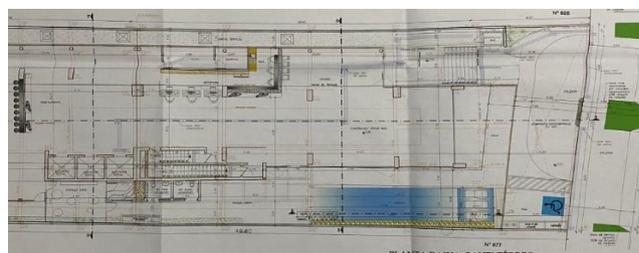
Foto de trecho da planta baixa do pavimento térreo do Hotel C.
